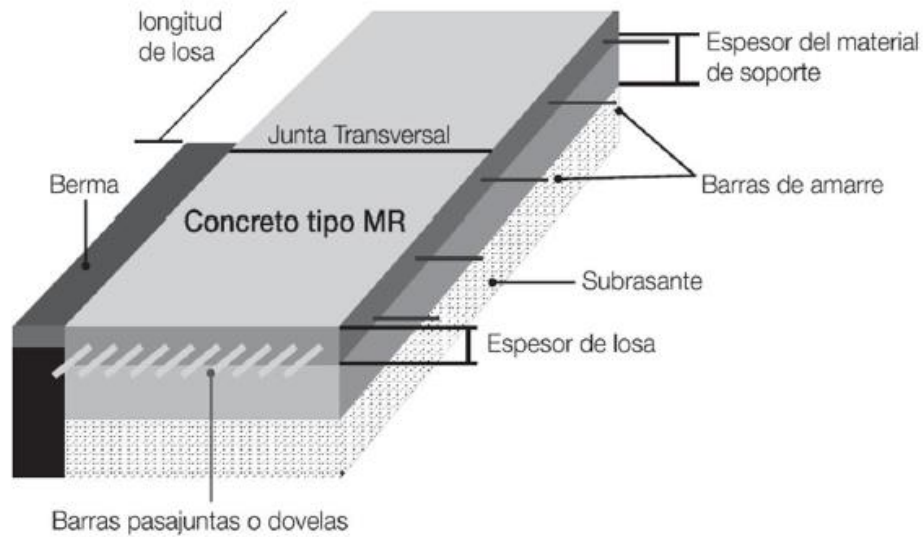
Esquema Diseño Estructural Pavimento Concreto Rígido 3D
